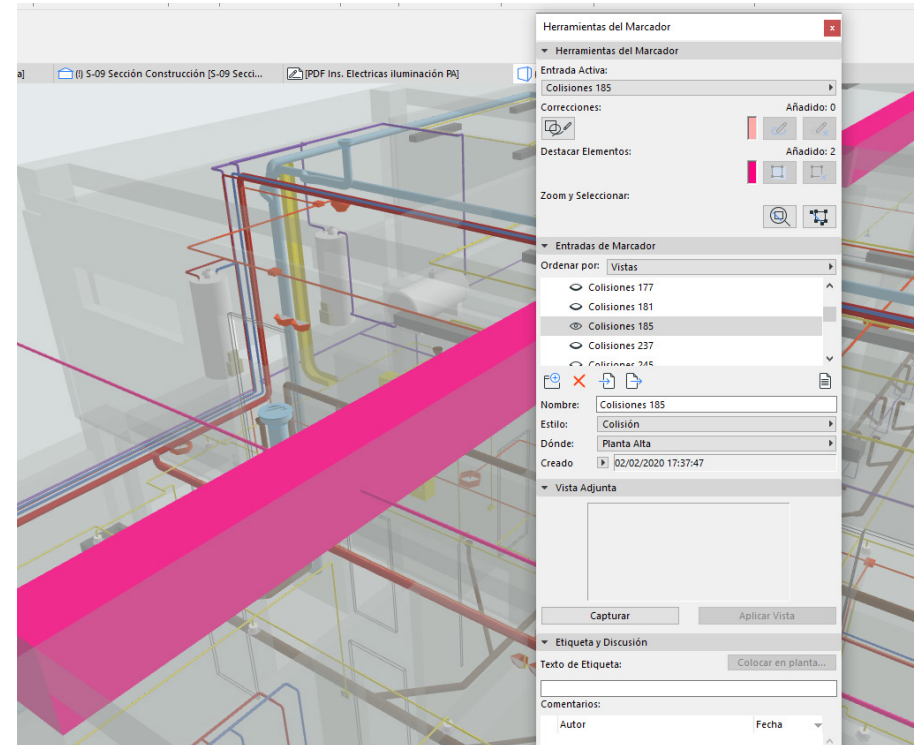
Colisión encontrada entre viga y tubería eléctrica. Elaboración: Del autor.
